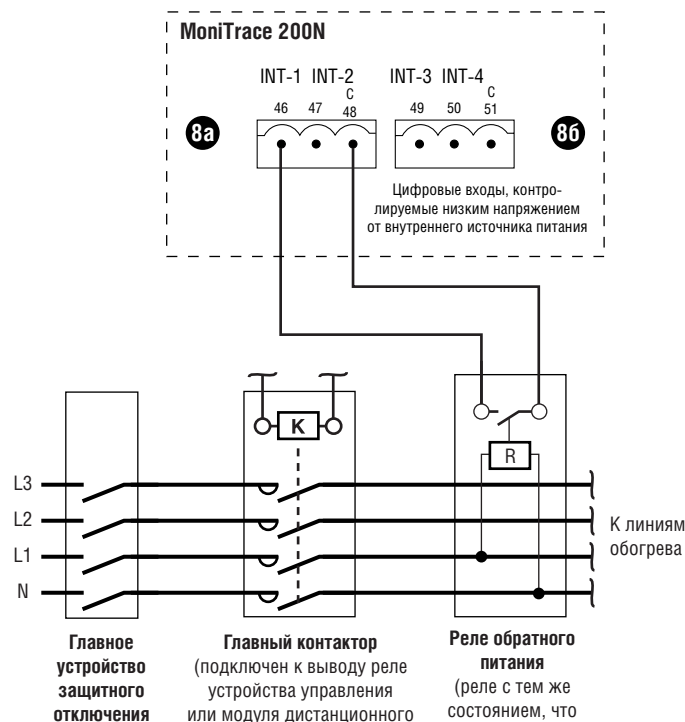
Схема реле обратной связи для проверки срабатывания контактора
